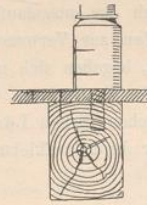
Treppengeländer. Verschraubung des Mäklers mit einer Blockstufe oder mit einem Wechsel und Sicherung durch Winkelisen.
